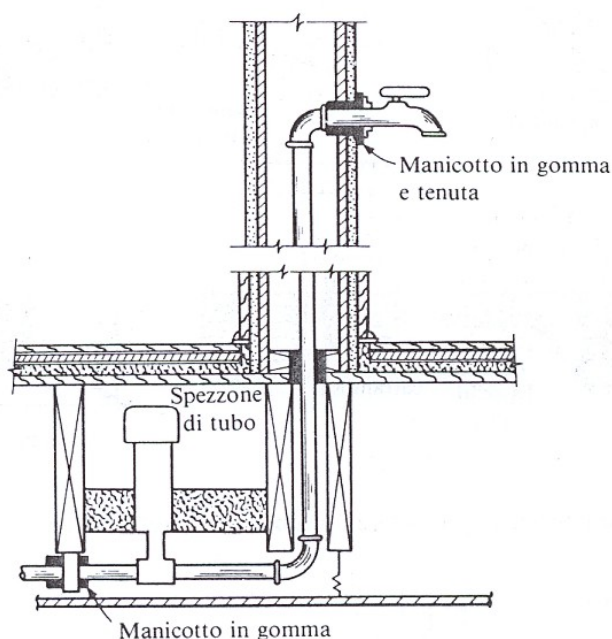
Esempio di schema di principio di isolamento delle tubazioni dalle strutture dell'edificio.
